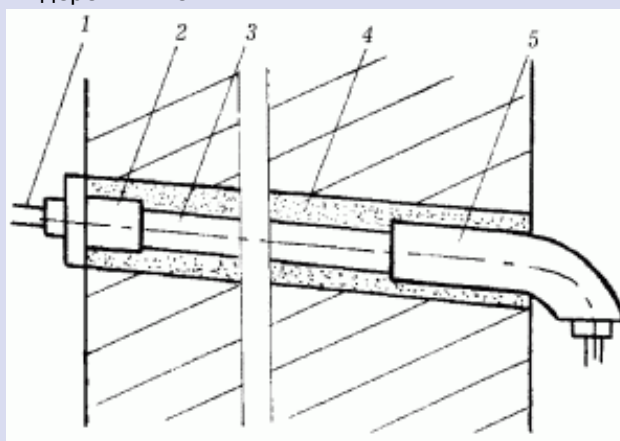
Проход провода ввода через стену: 1 – провод ввода; 2 – втулка; 3 – изоляционная трубка; 4 – цементный или алебастровый раствор; 5 – фарфоровая воронка.
